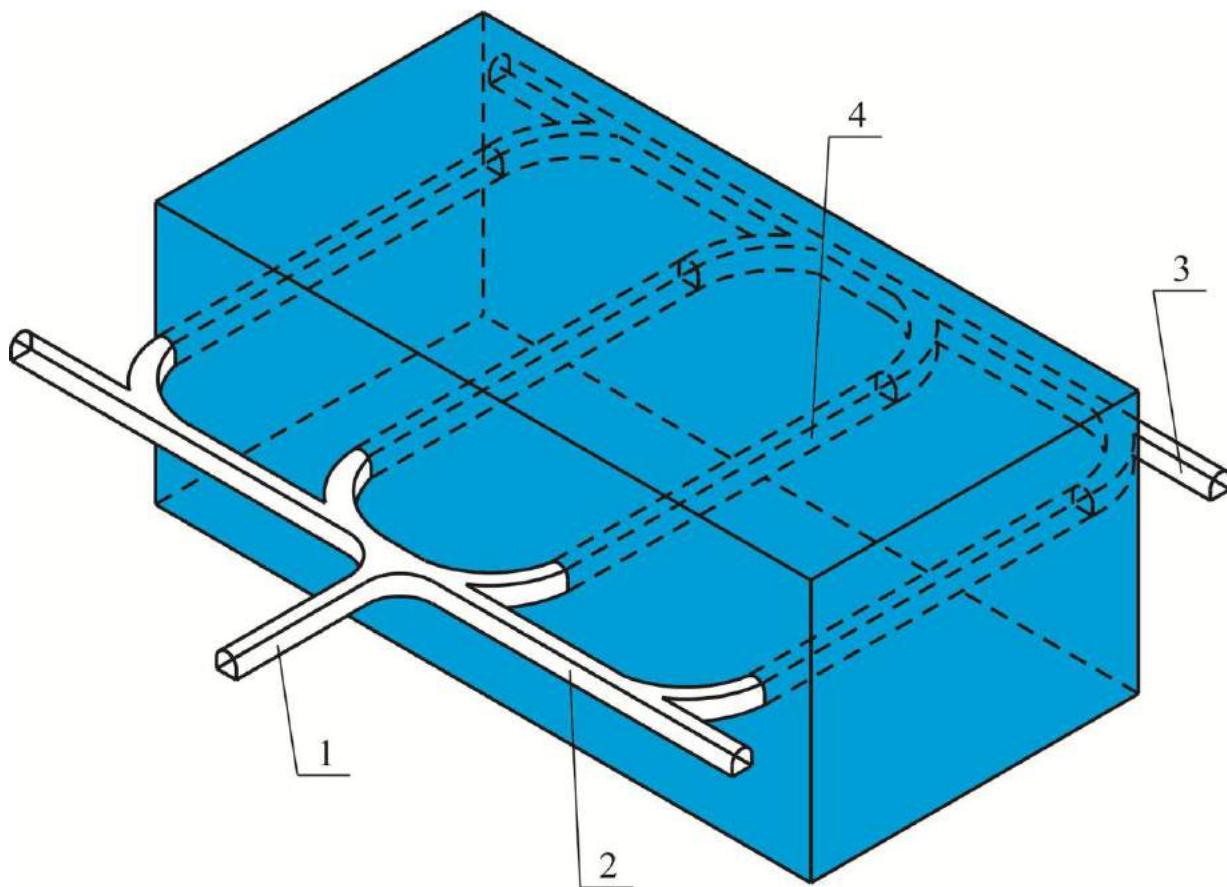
Схема подготовки полевыми штреками лежачего и висячего боков и кольцевыми ортами: 1 – квершлаг; 2 – полевой штрек лежачего бока; 3 – полевой штрек висячего бока; 4 – кольцевой орт
